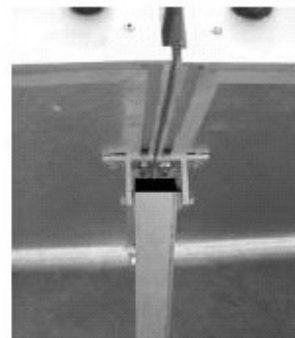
Support pour implantation sur toiture terrasse ou au sol
